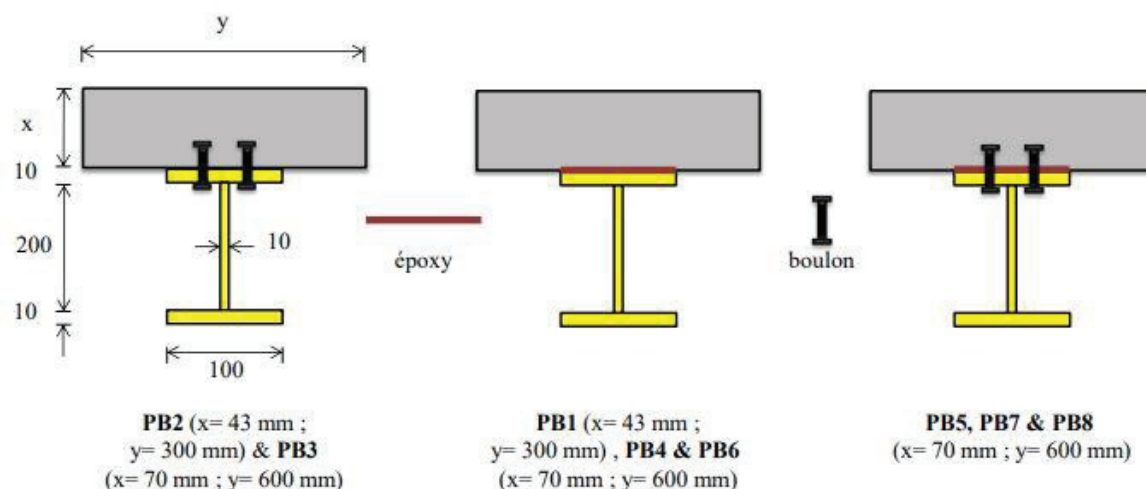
Configurations des poutres GFRP-béton testées par [KOA 2017]
